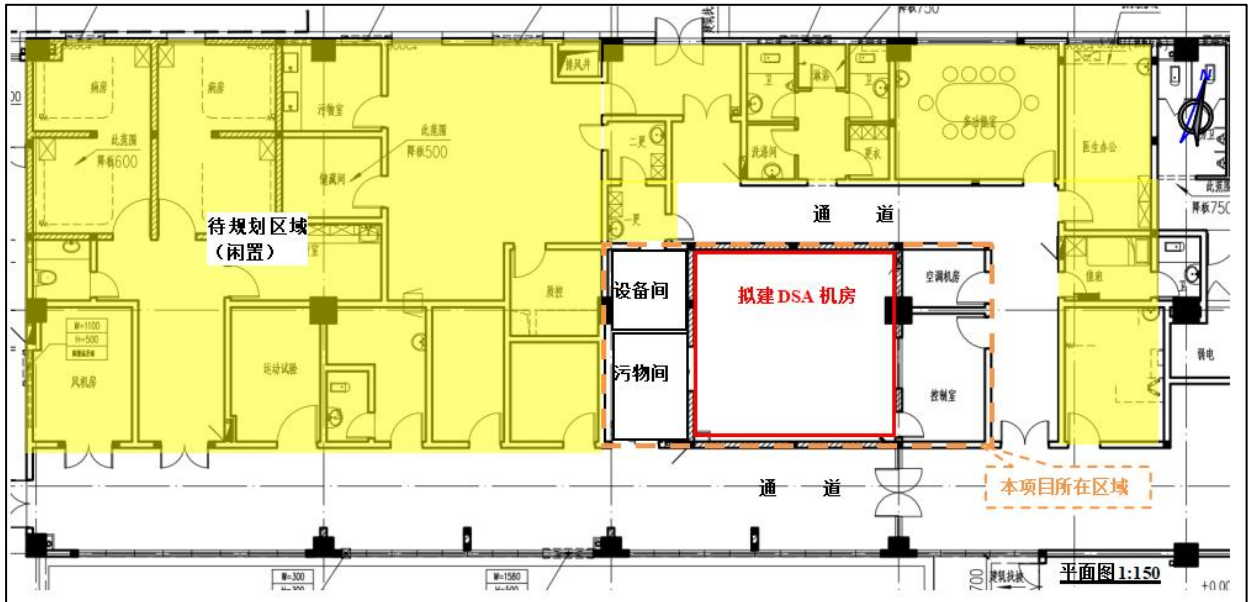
门诊医技楼一层平面局部示意图（本项目所在楼层）
